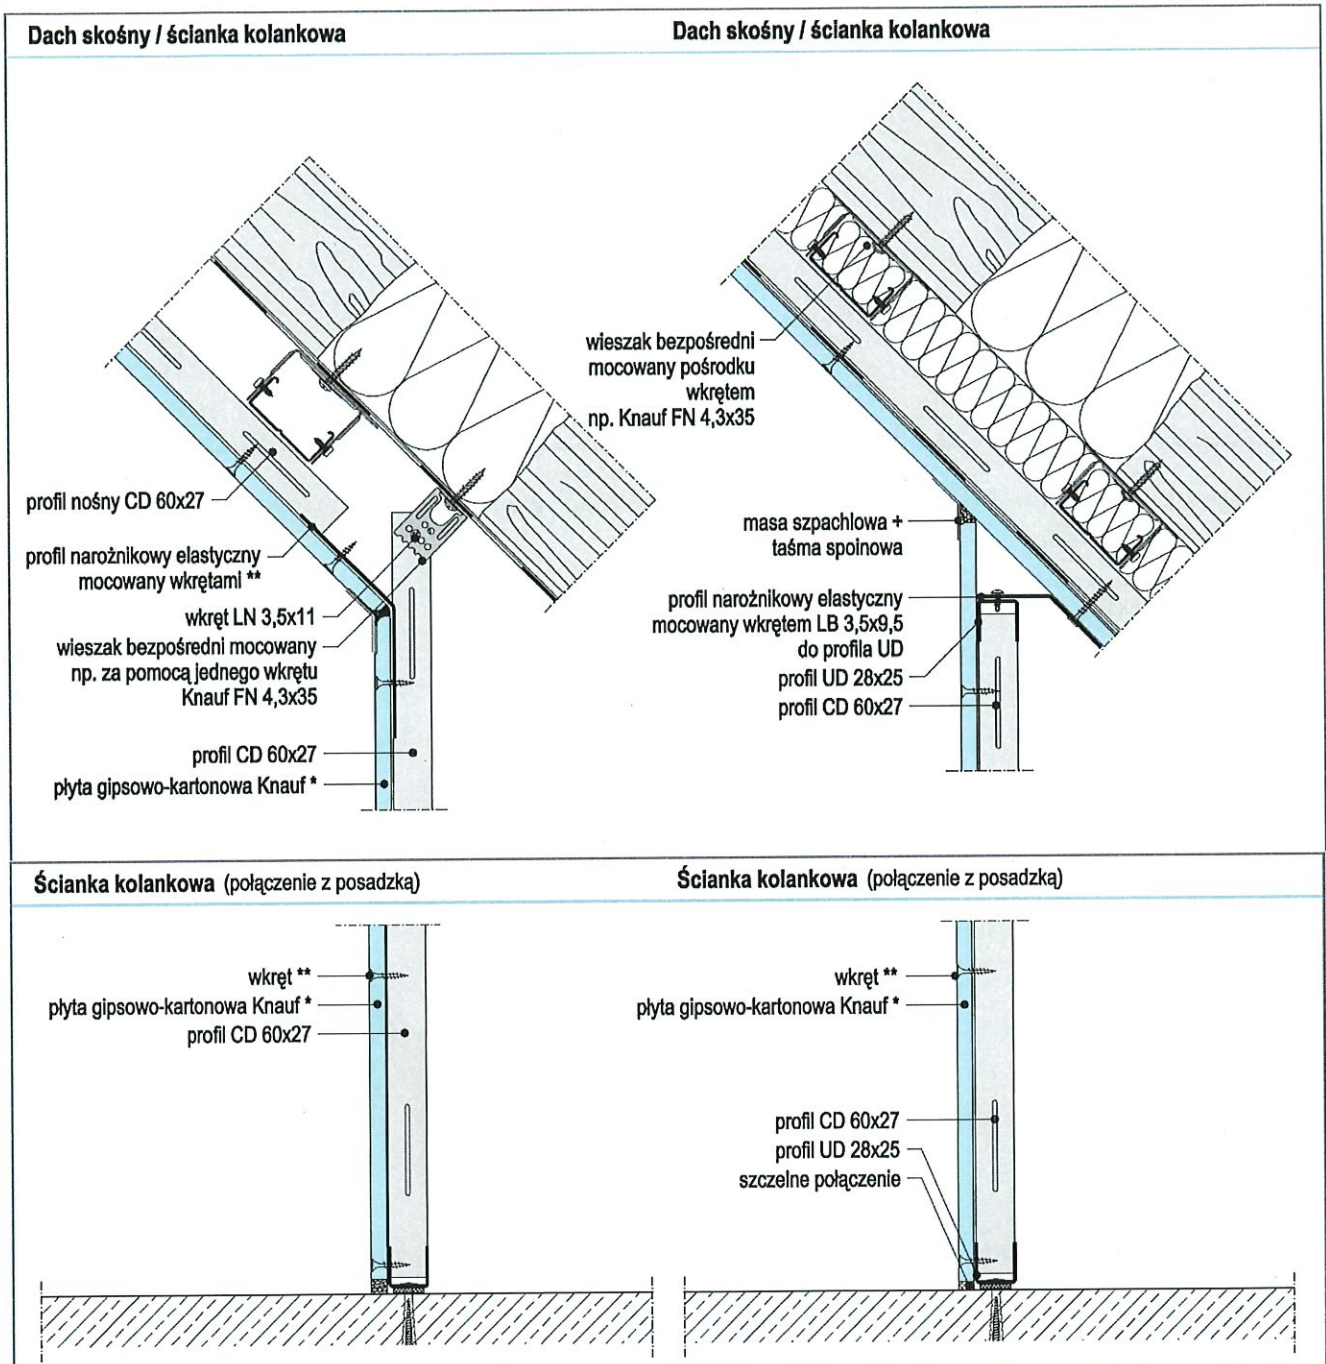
System D612.pl na konstrukcji krzyżowej z profilem CD60, z wieszakiem bezpośrednim, przekrój pionowy dachu spadzistego.
